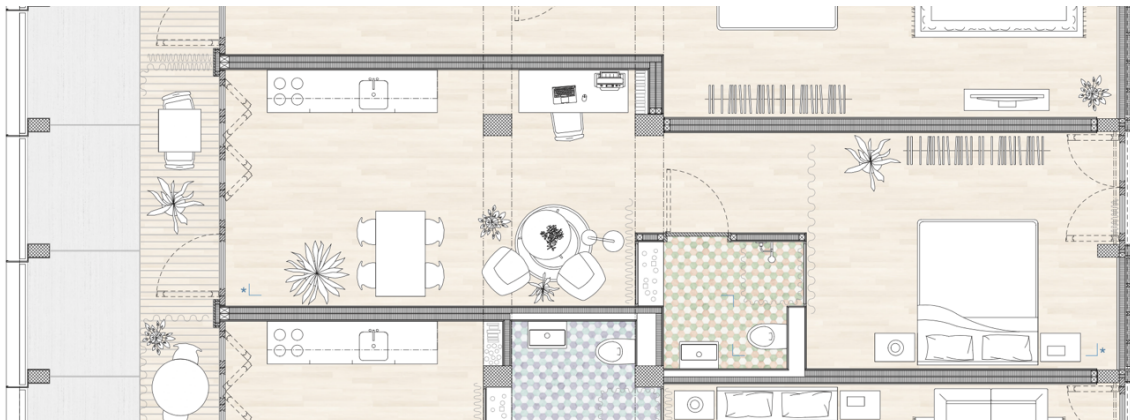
Grundriss Kleinwohnung «Hochbergerstrasse» (Hochbergerstrasse, 2021, o. S.)
